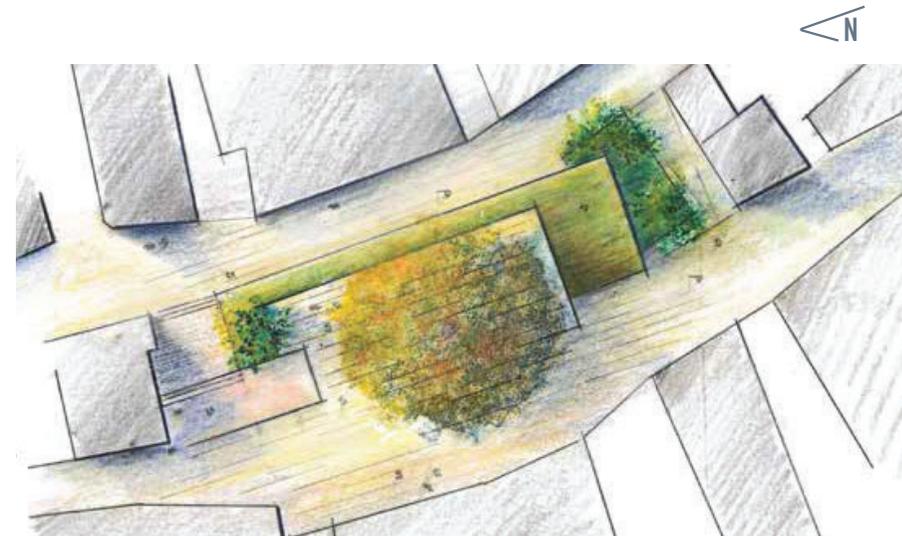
Variante 1 - Grundriss Ausschnitt
